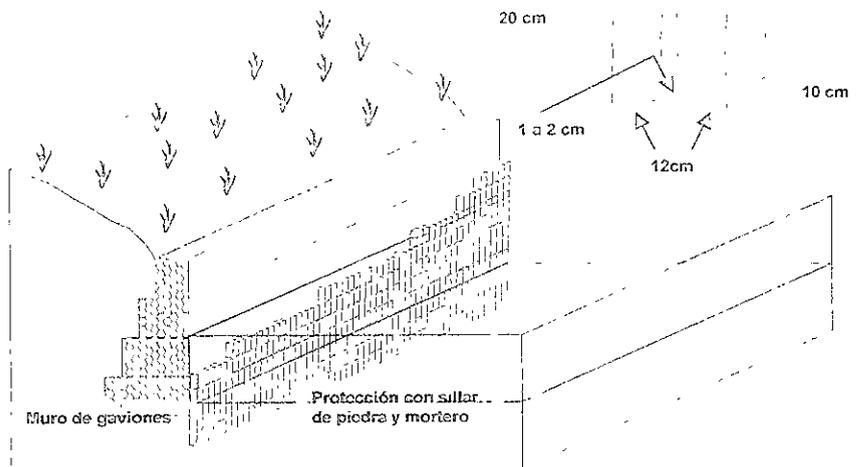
Protección de gaviones con muro de sillar de piedra juntado con mortero
